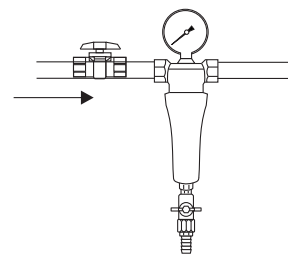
Установка на трубе с горячей водой одинарного корпуса.
